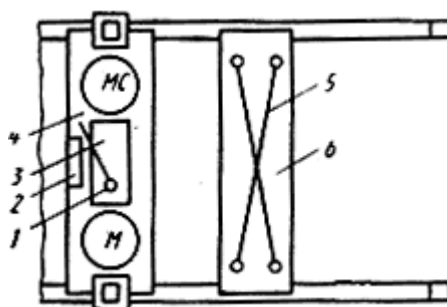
Схема организации рабочего места при монтаже плиты перекрытия
